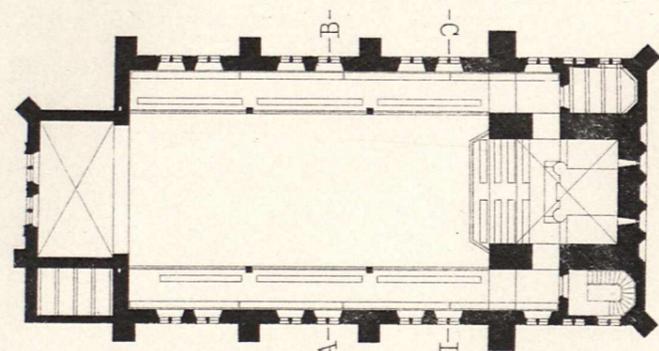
Grundriss in Höhe der Emporen.
